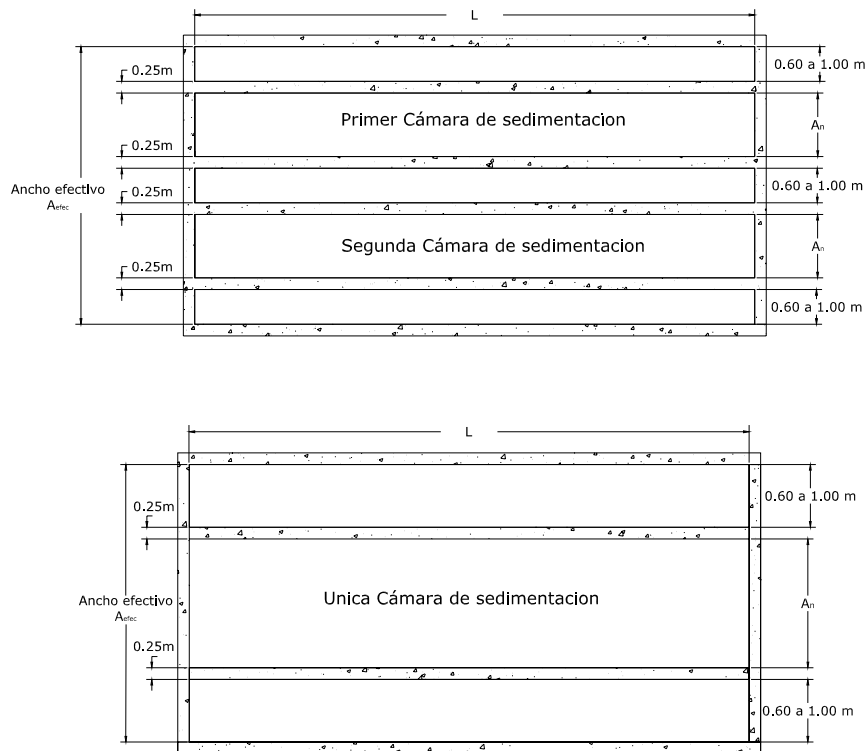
Vista en Planta de tanques Imhoff con una y dos cámaras de sedimentación
